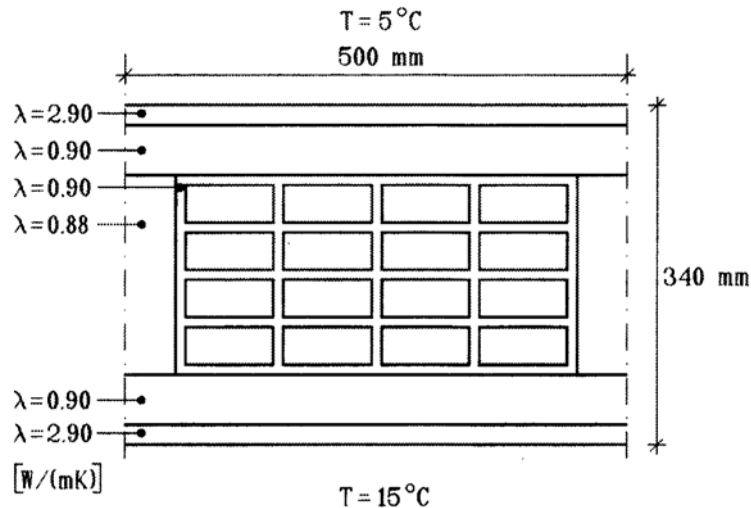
Betrachteter Ausschnitt des Hohlziegeldachs mit 16 Hohlräumen.
